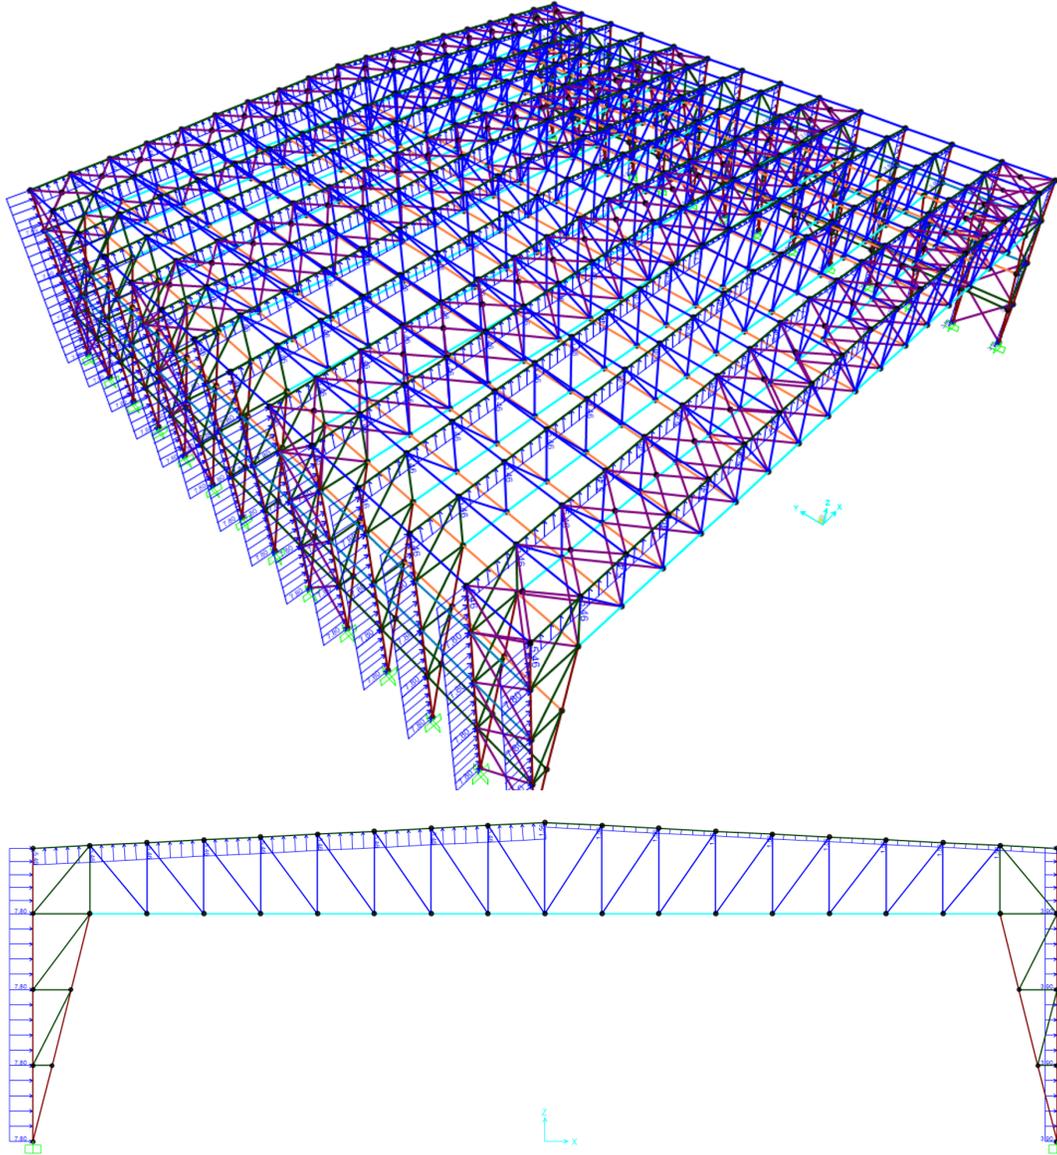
Carga de viento de succión caso 1 sobre la estructura 3D y el pórtico tipo. Elaboración propia.
